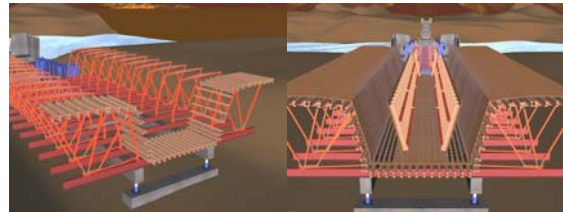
Montagem de cofragem e colocação de armaduras e de cabos de pré-esforço.
